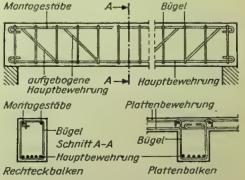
Bewehrung eines Stahlbetonbalkens mit Rechteck- und Plattenbalkenquerschnitt
